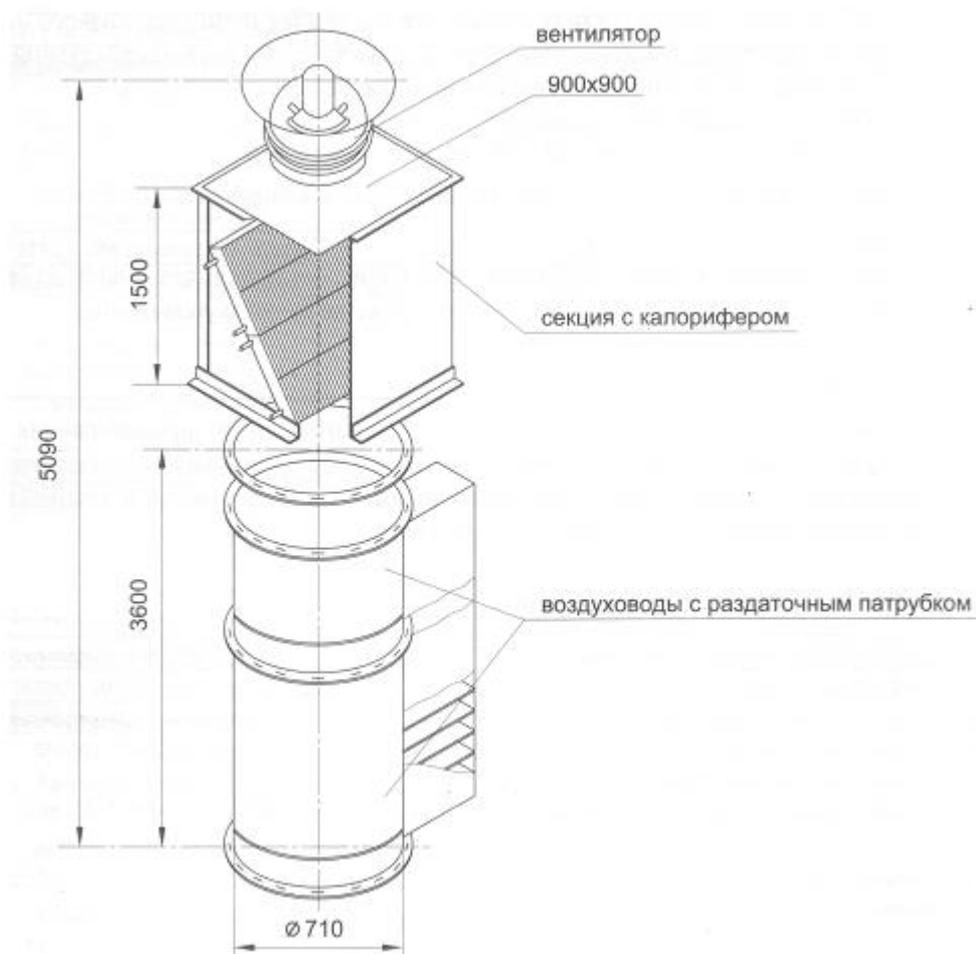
Конструкция несущего стояка воздушной завесы заводского изготовления
